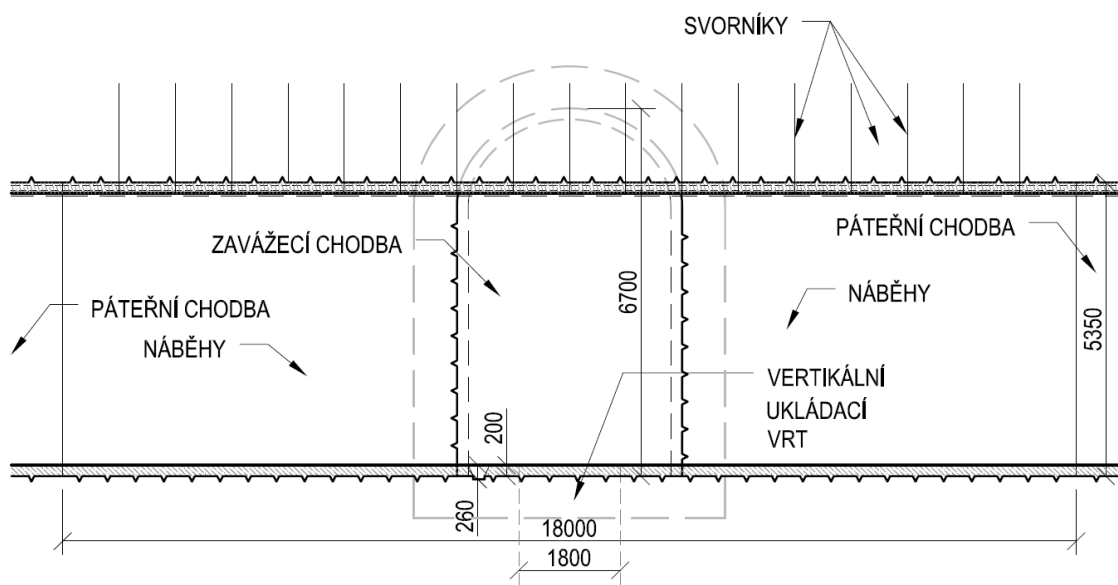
Půdorysné schéma ukládání – varianta D2
